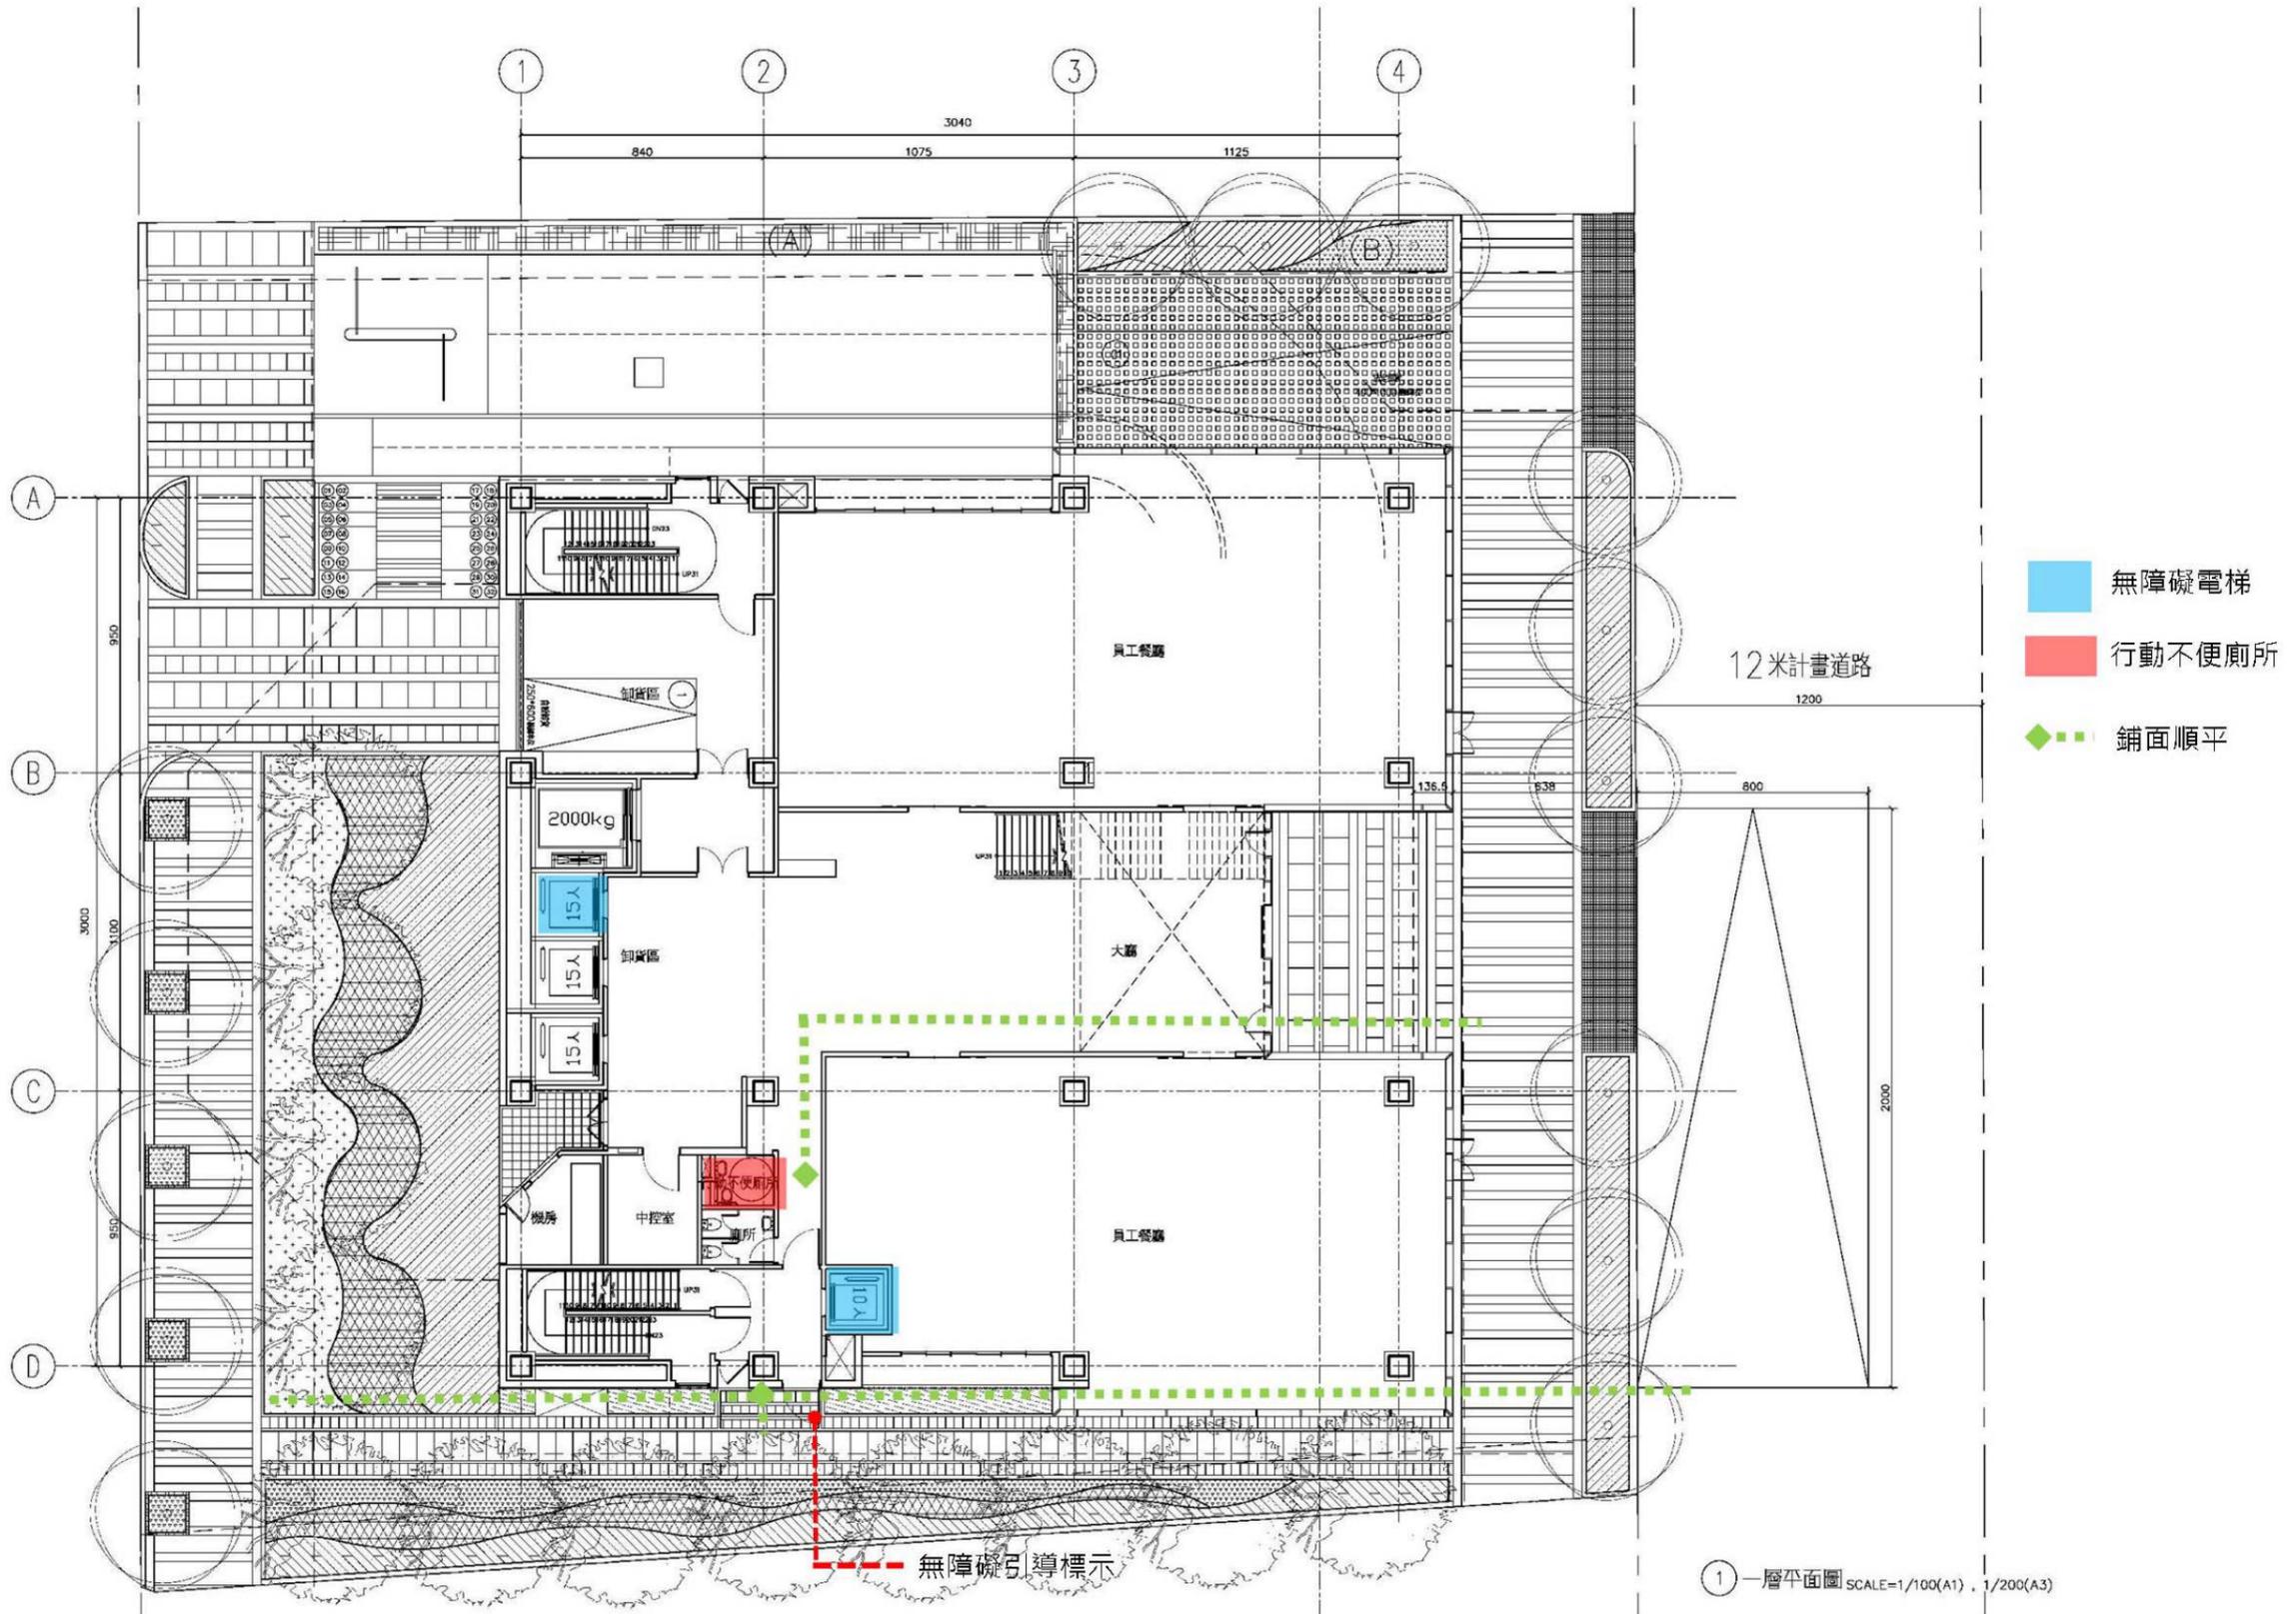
地上一層平面無障礙空間引導設施系統示意圖
